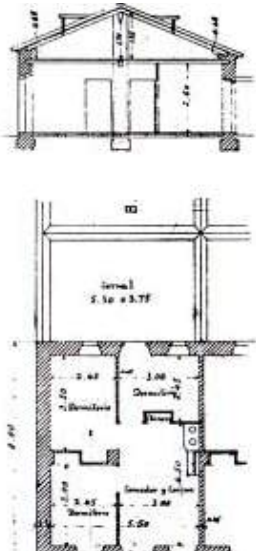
Vivienda para mineros en el pueblo de El Valle (Archivo de los autores).
